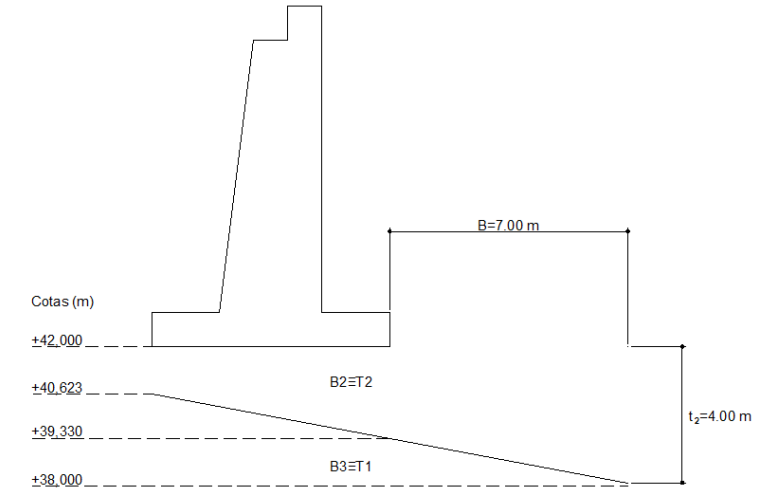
Figura XII: SECCIÓN DEL ESTRIBO EN EL TERRENO ESTRATIFICADO
